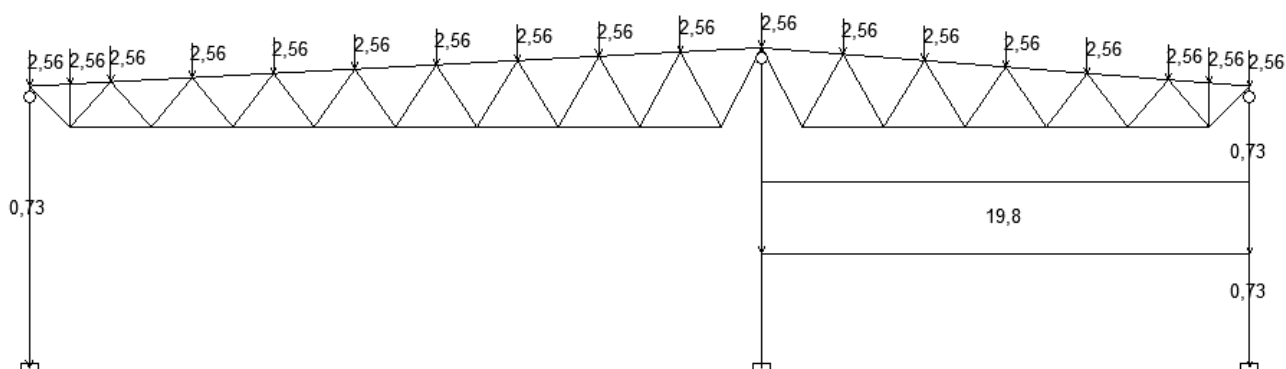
Схема загрузки от постоянных нагрузок
